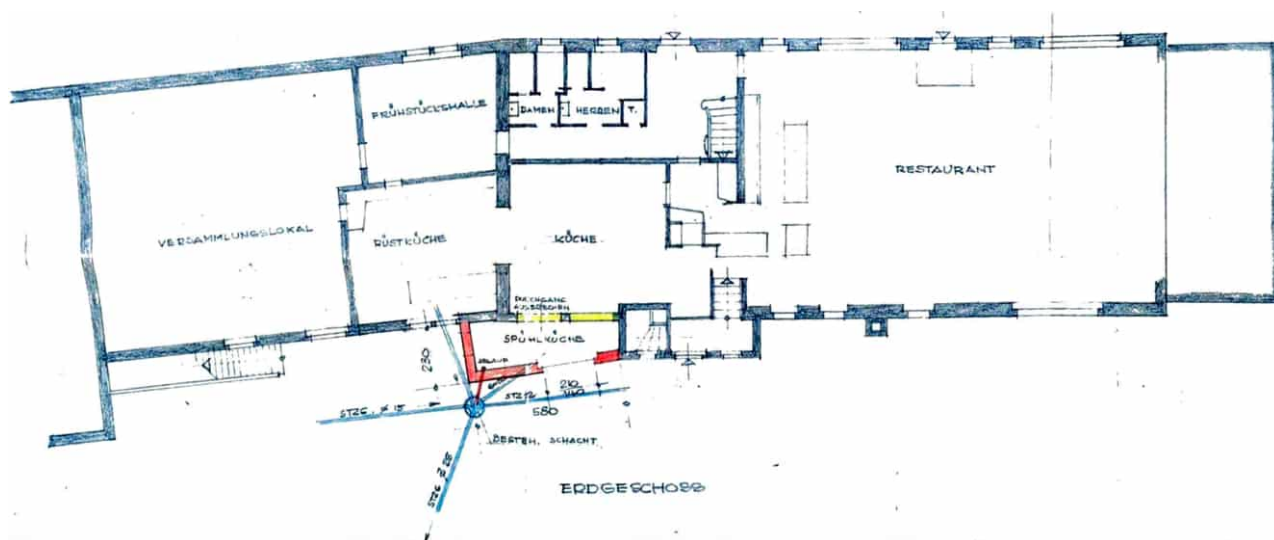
Umbauplan 1970 (Ausführungsplan): Küchenerweiterung. Keine Angabe bereits durchgeführter nicht bewilligter Innenumbauten.
